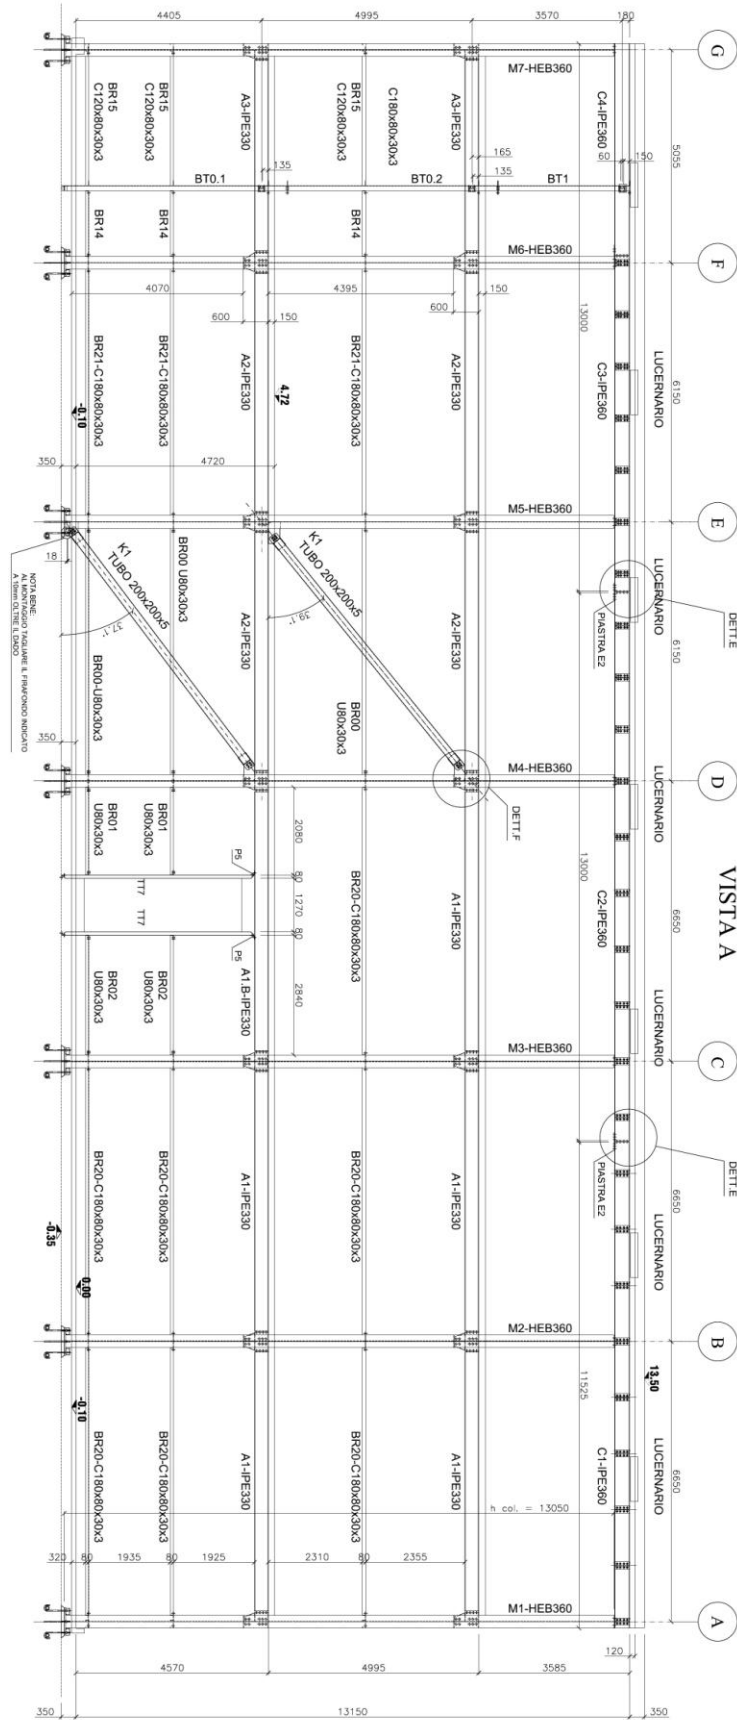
Particolare di A.2006.a.us.T04 - Prospetti e sezioni 1 - Prospetto Ovest
